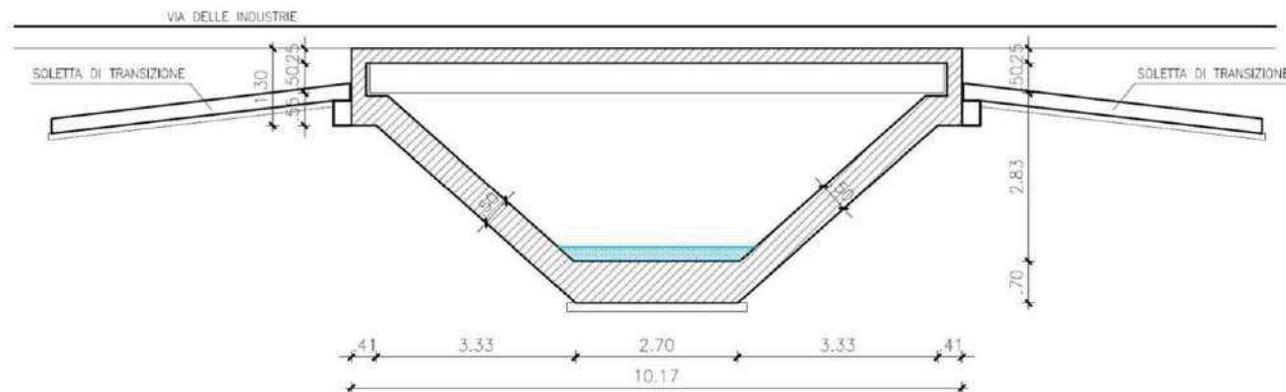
Sezione trasversale ponte sul fiume Dosson
